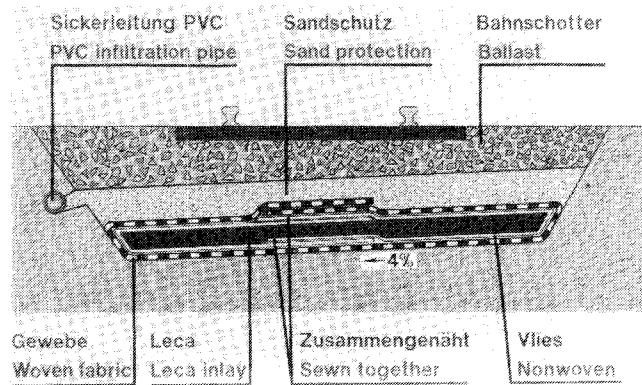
Gleisbau (Plan Gleisunterbau Bahnhof Wauwil, CH)
